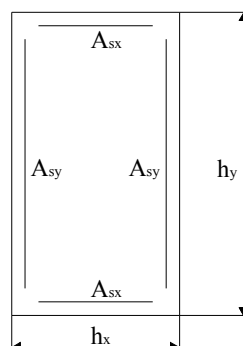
Distribuição das barras da armadura longitudinal nas faces do pilar conforme assumida pelo aplicativo.
